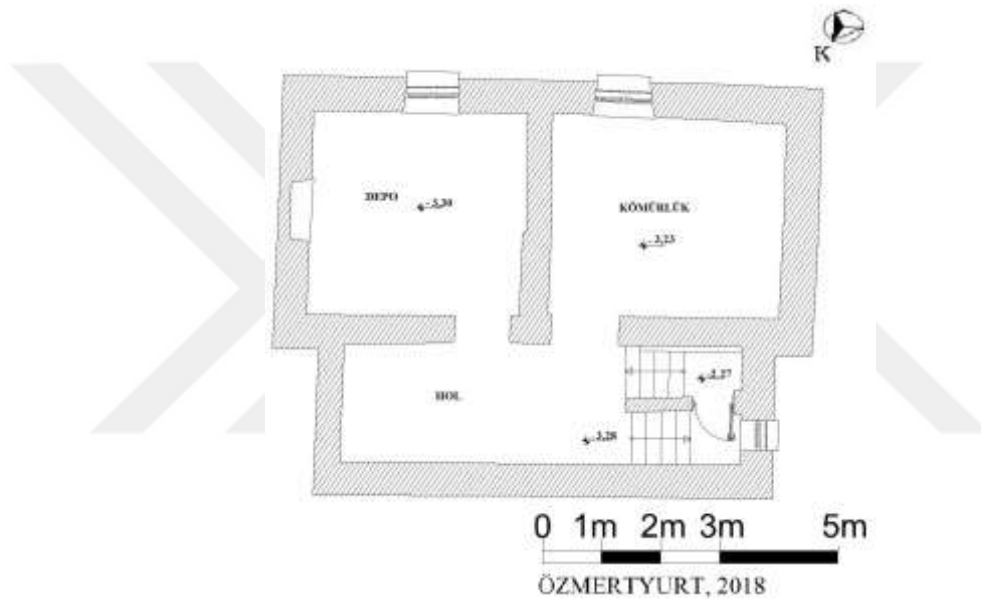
Gar Lojman Binası 2, Zemin Kat Planı
